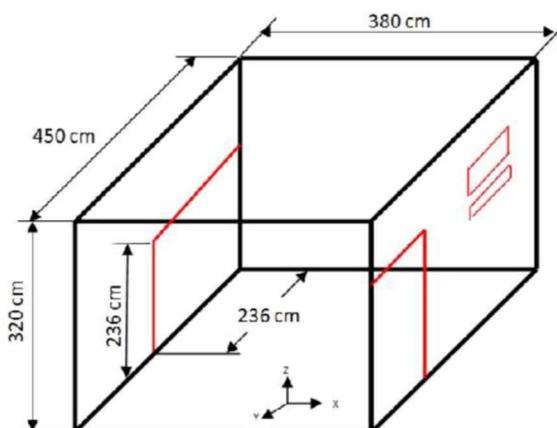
3d схема произвольного помещения, где планируется произвести расчет тепла
